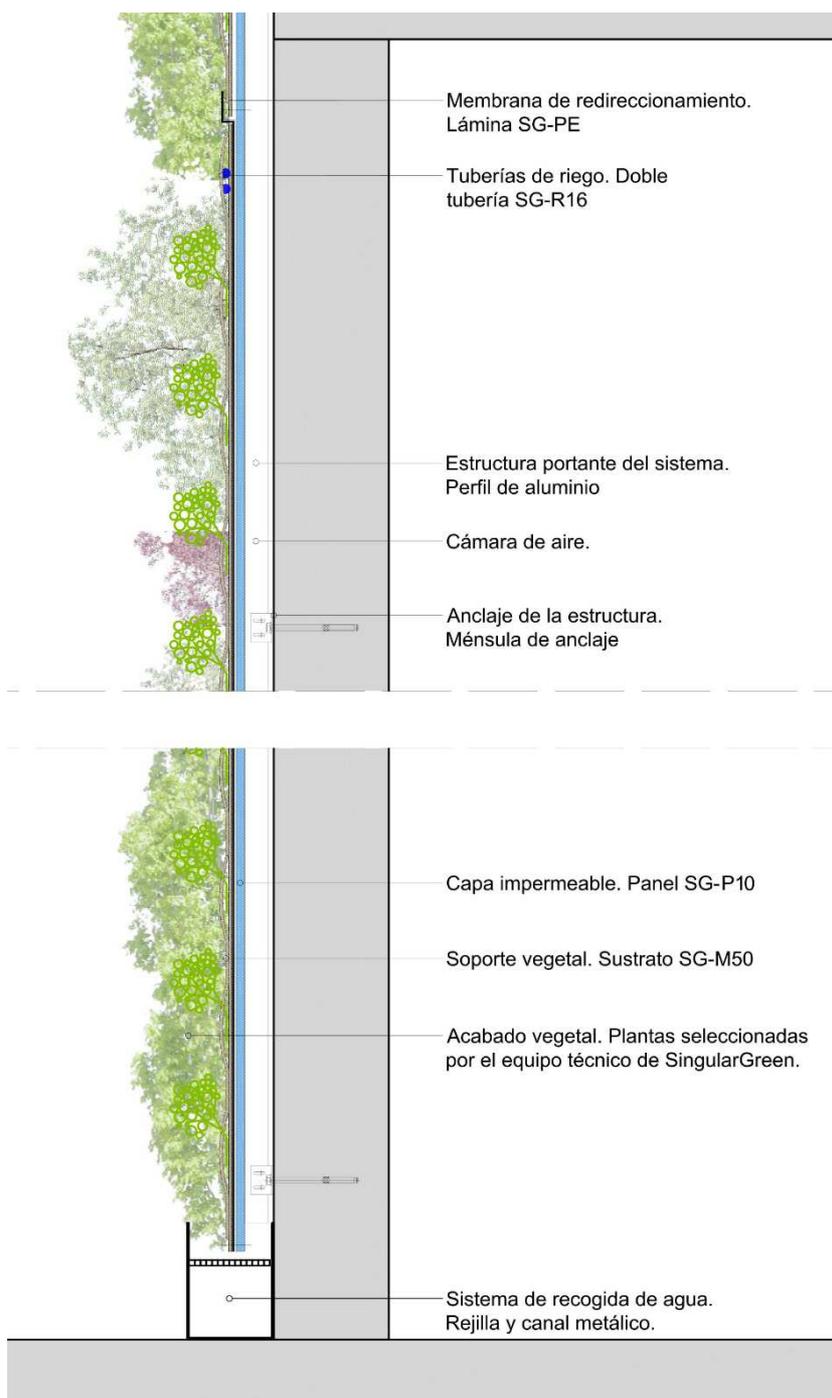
Detalle constructivo Jardín Vertical F+P [2]
